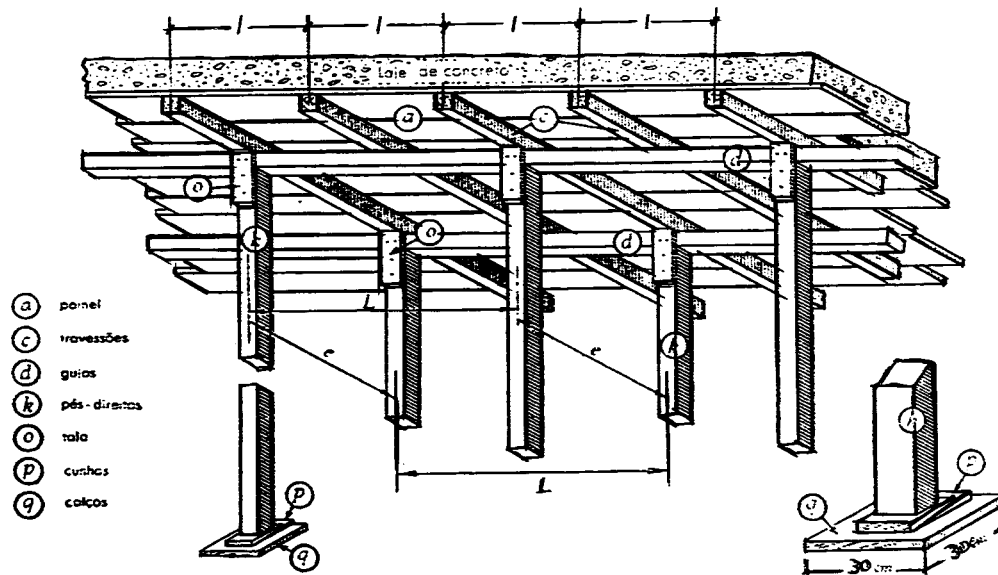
Disposição típica de painéis de lajes de escoramento (Fonte: ABCP, 1943).
